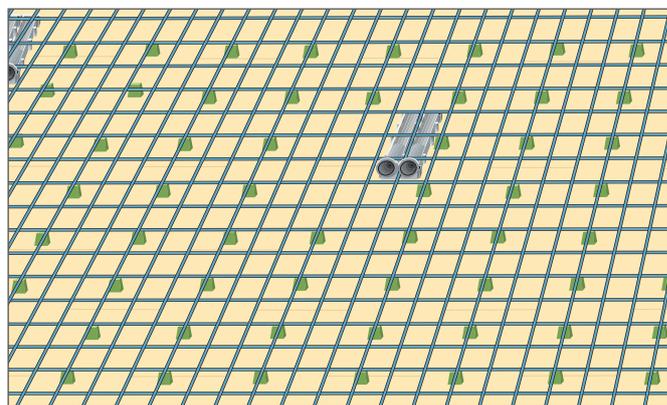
Punto 1 - Montaggio delle casseforme
